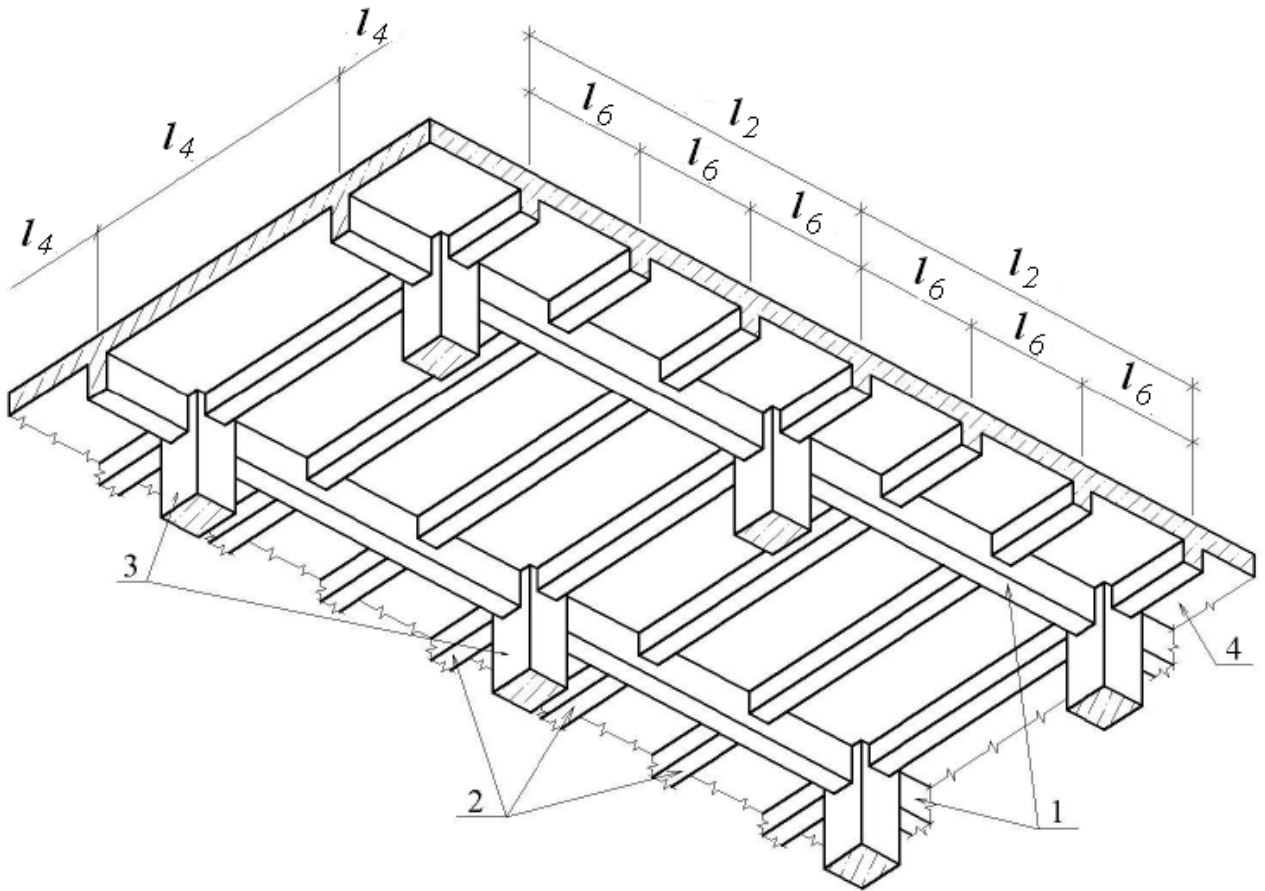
Монолітне ребристе перекриття з балочними плитами:
